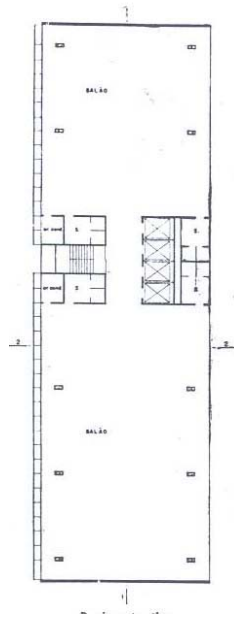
Planta pavimento tipo - Fonte: ACROPOLE, n° 255 janeiro,1960, p. 89.
